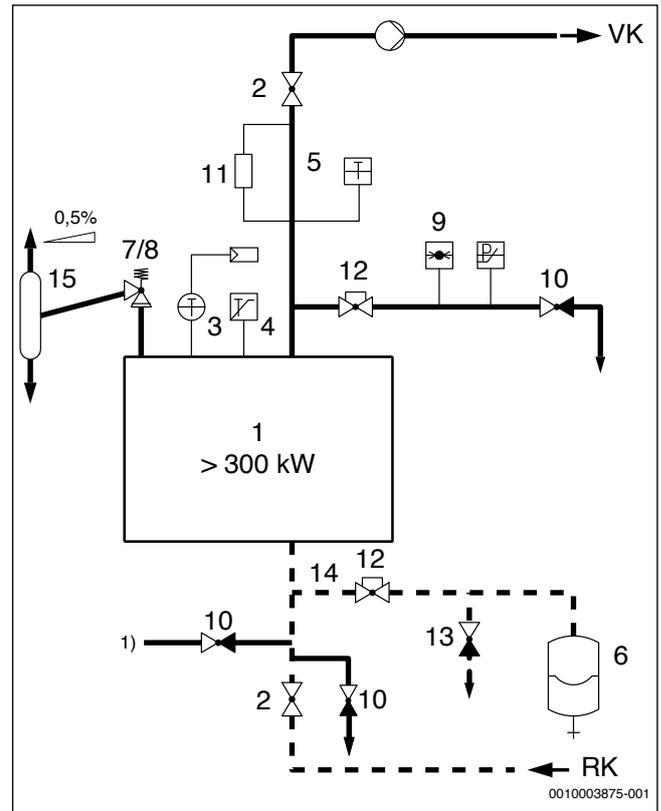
Equipaggiamento tecnico di sicurezza UNI EN 12828 per caldaia > 300 kW
